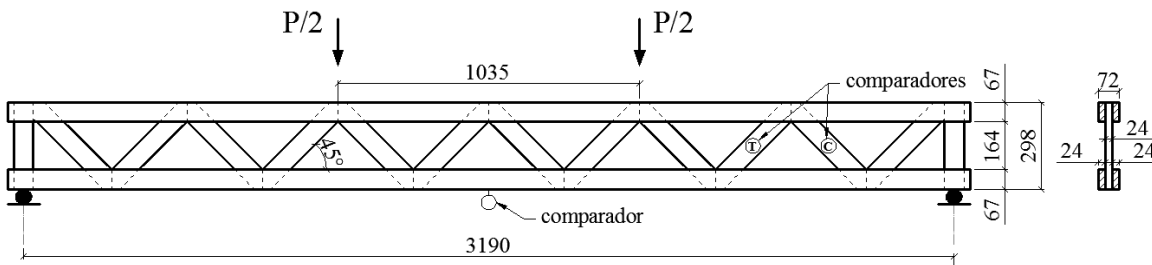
Configuración general de las vigas reticuladas. T y C: dispositivos para registrar el deslizamiento en las conexiones de una diagonal traccionada y una comprimida respectivamente. (Dimensiones en mm).
